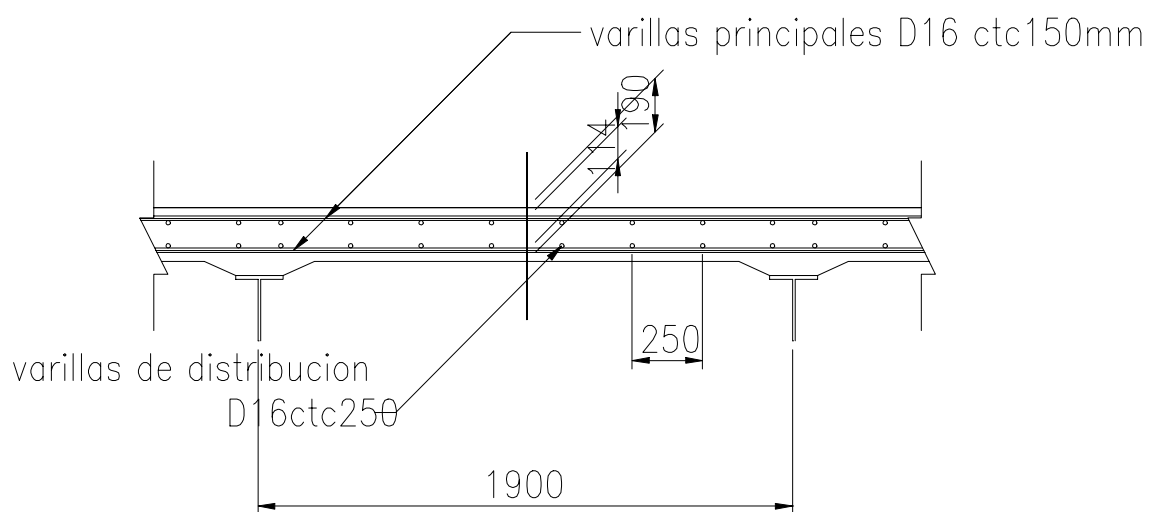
Sección de corte de la distribución de varillas en las losas
